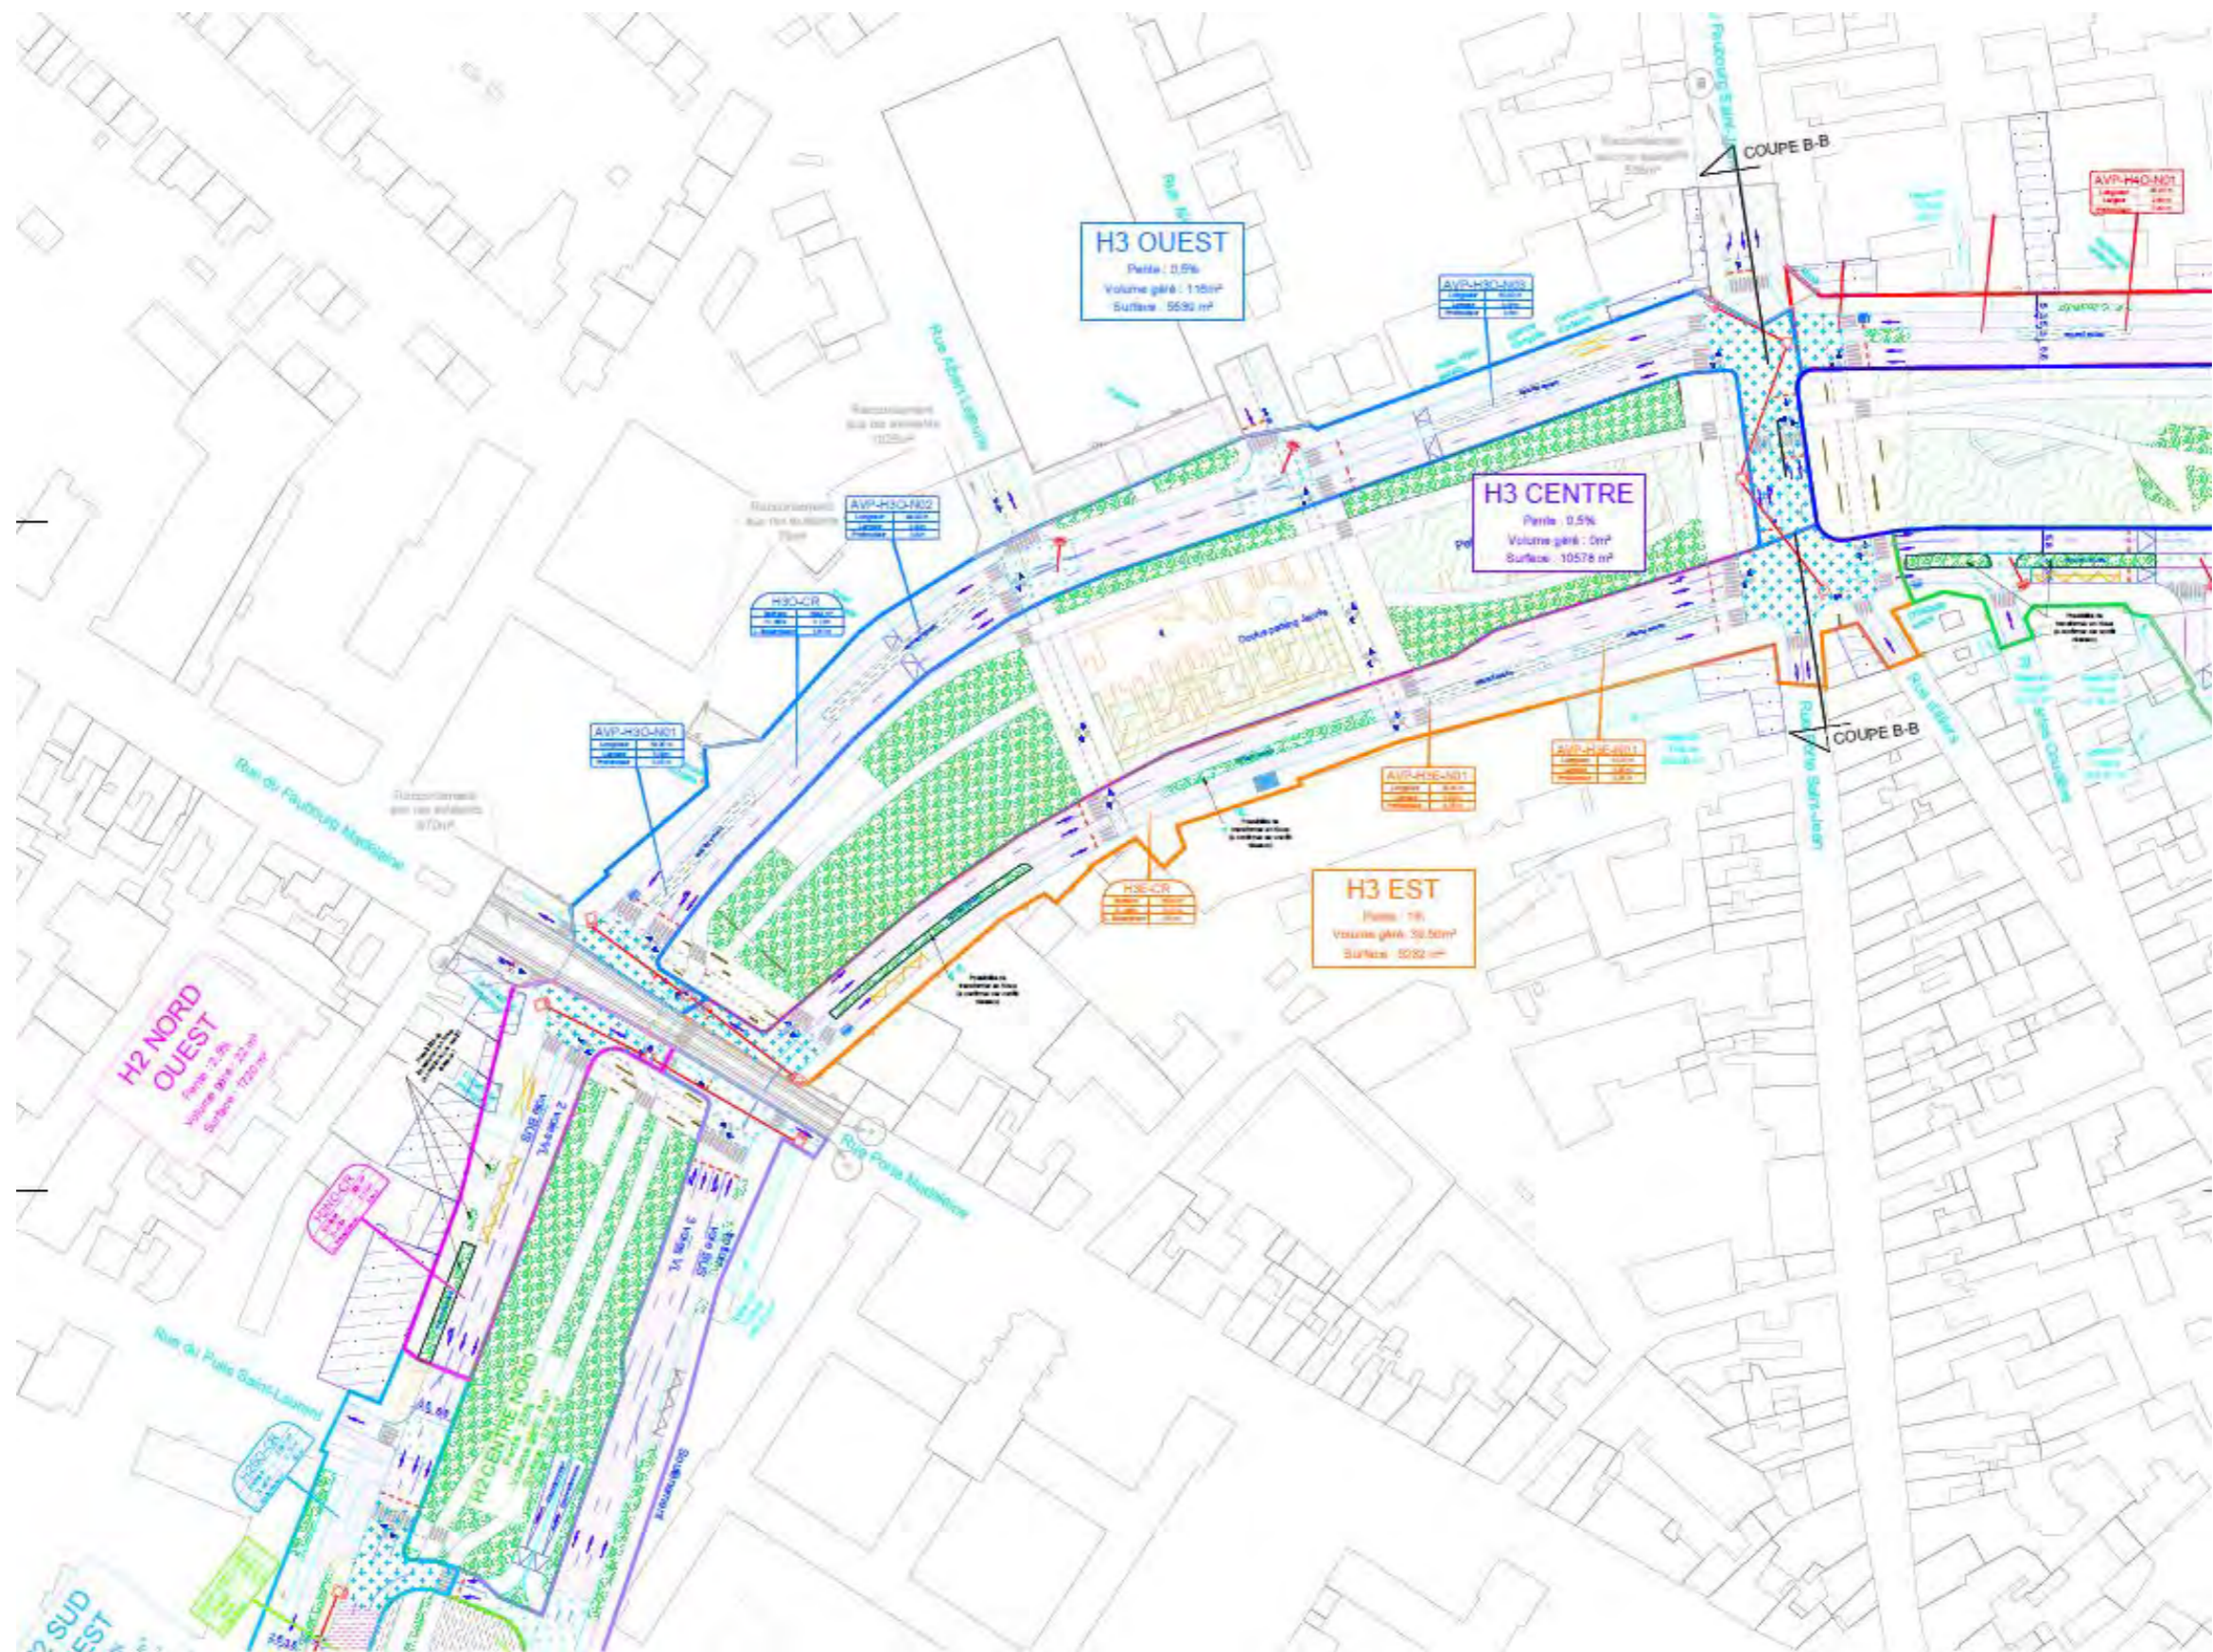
Plan principe d'assainissement (2/6) (source : AVP, 2024)
